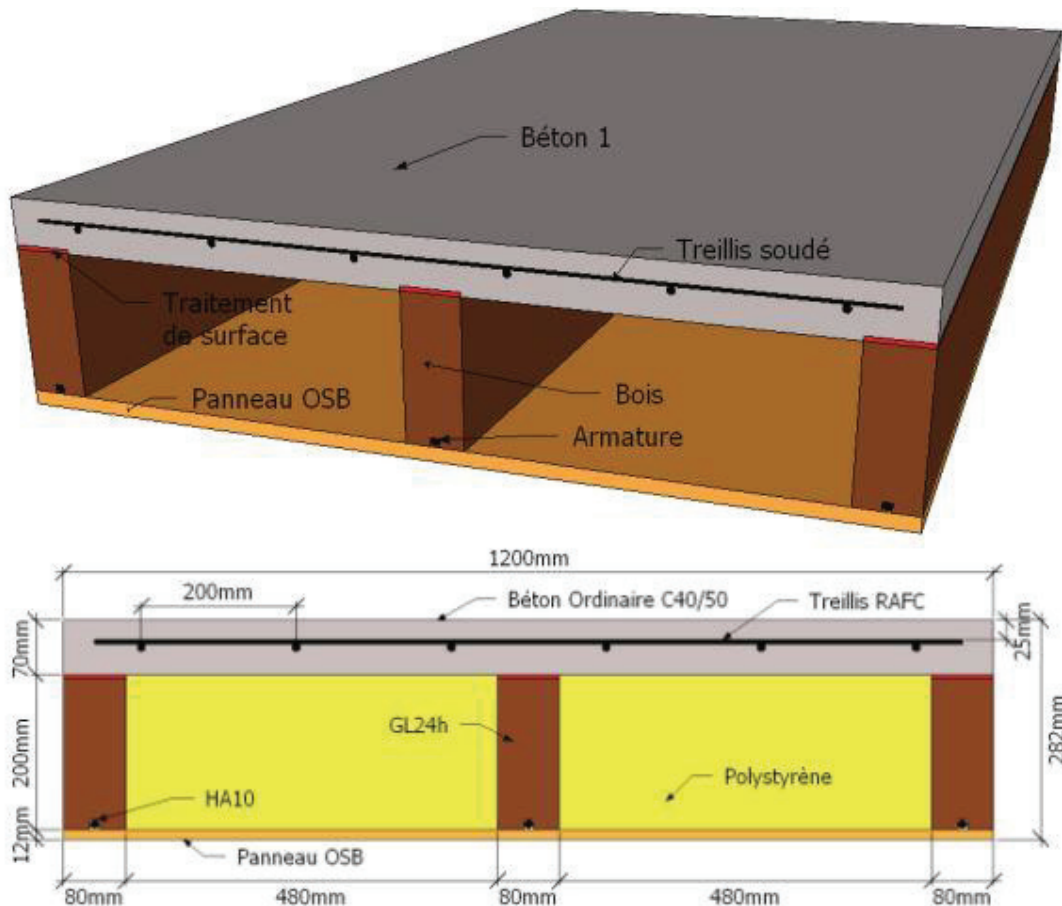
Plancher bois-béton testé en flexion [AUG 2019]
